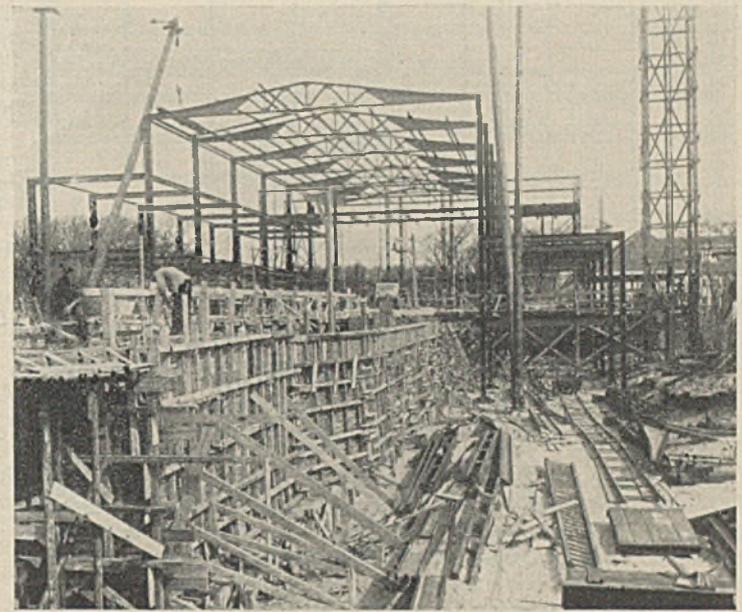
Montage des Hallenschwimmbades in Norderney.
